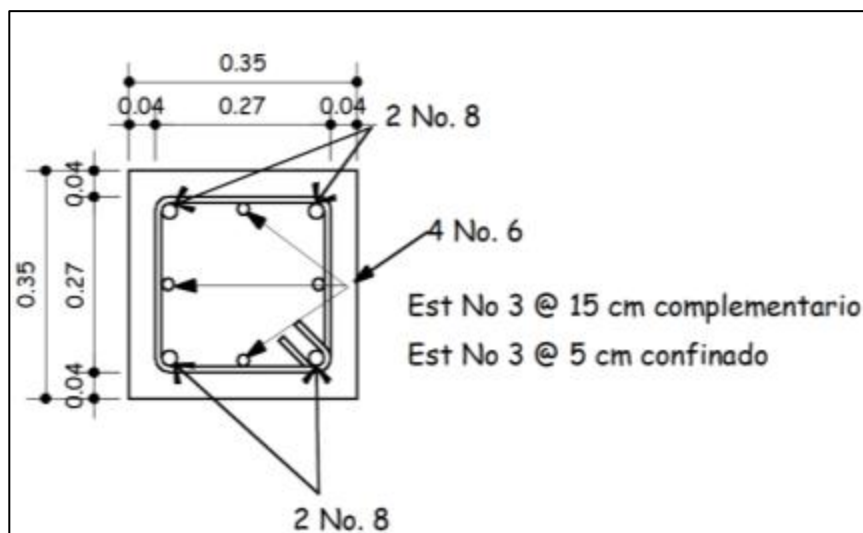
Detalle de armado de columna principal C-1, módulo 1
